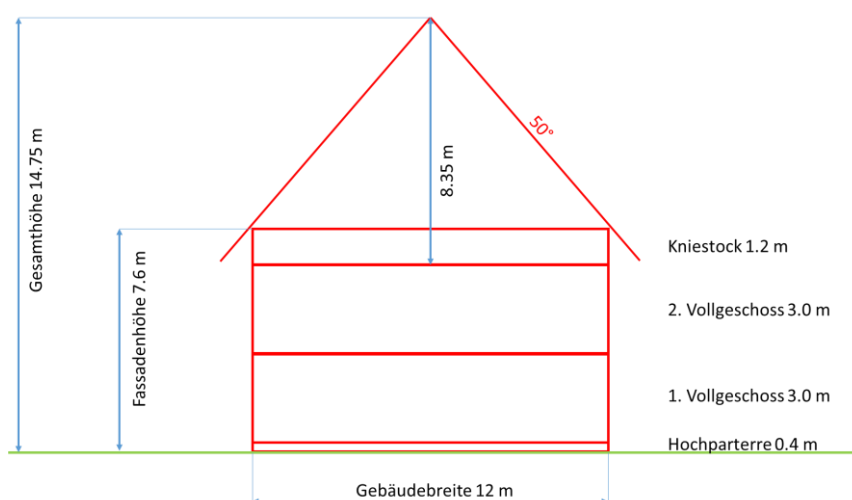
Schrägdachbau Dorfzone mit neuen Höhenmassen
